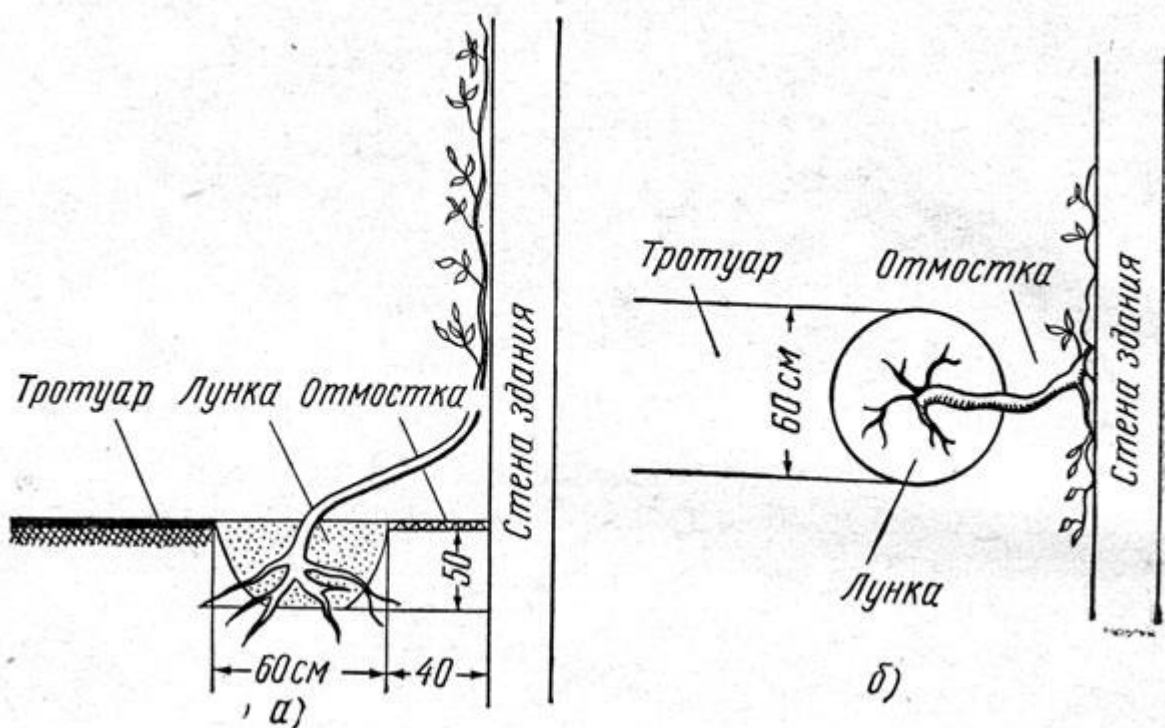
Пристенное размещение вьющихся растений: а - вертикальный разрез, б - план
